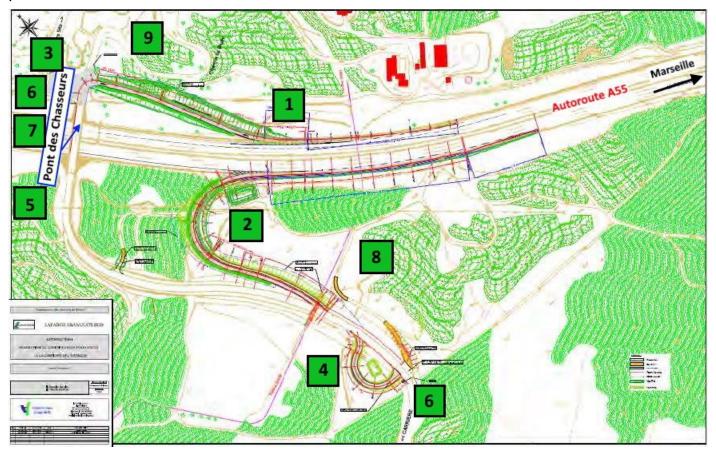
PLAN DE MASSE DU PROJET ET AMENAGEMENTS PREVUS
